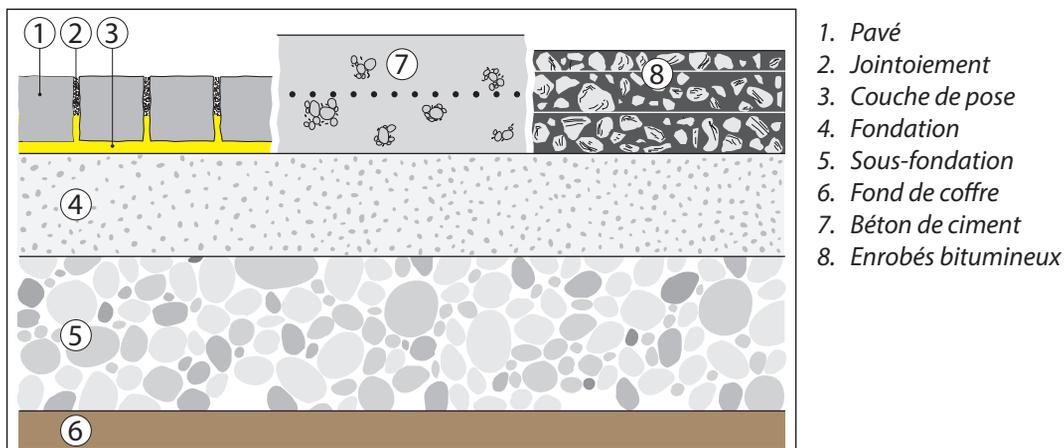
Structure d'une chaussée (schéma de principe) [33, p. 3]
